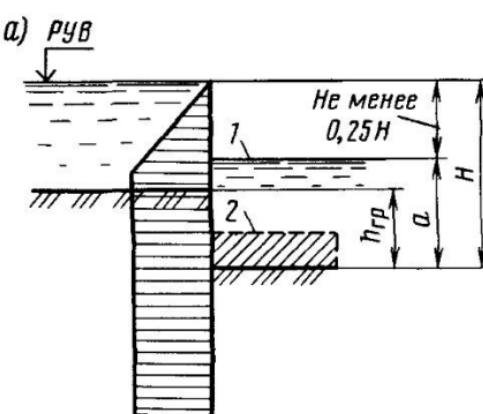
Эпюра гидростатического давления при устройстве ограждений без креплений с подводной тампонажной подушкой:
